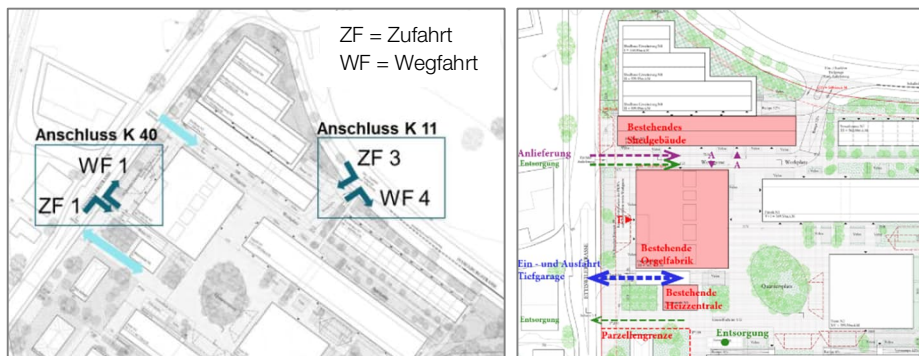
Erschliessung Areal ab Ettiswilerstrasse und Umfahrungsstrasse (RAPP AG, 2025)
